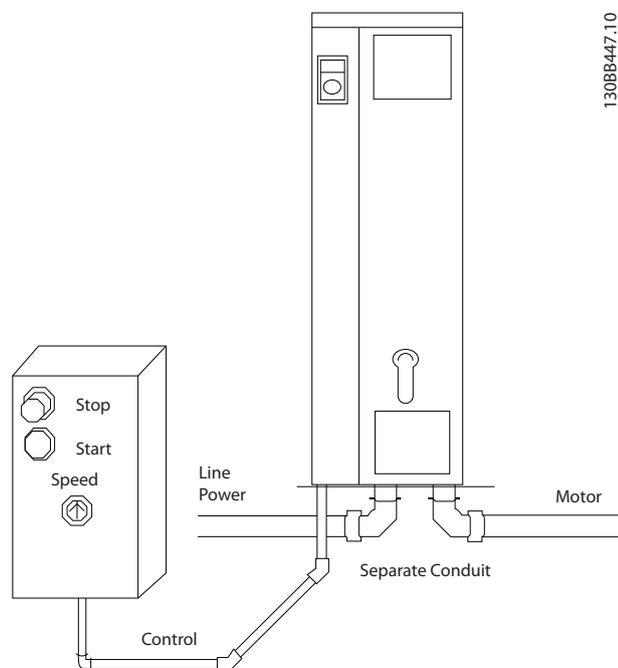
Правильный электромонтаж с использованием кабелепроводов
